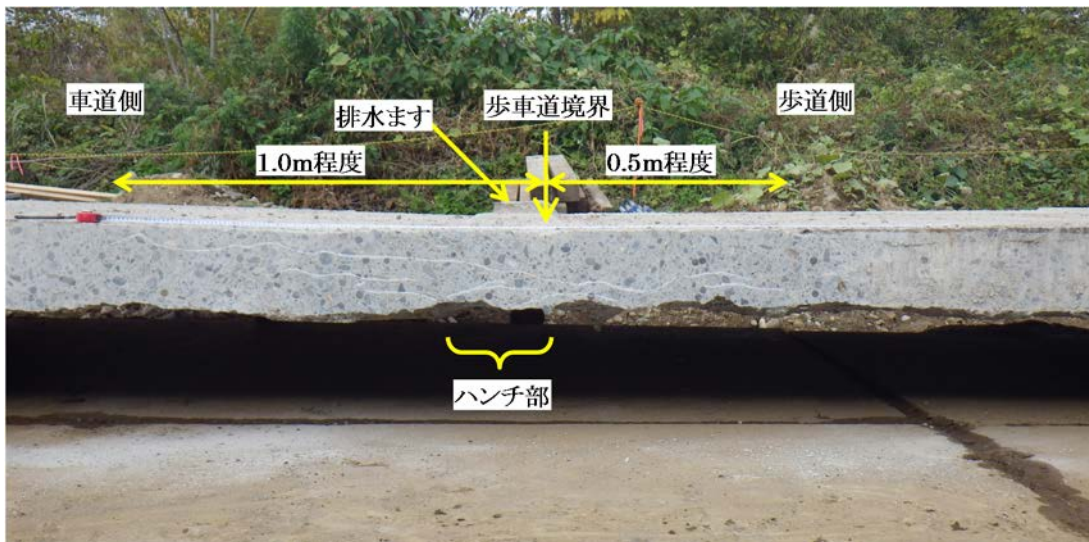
事例 12, 撤去時の床版切断面, 歩車道境界付近の水平ひび割れ
